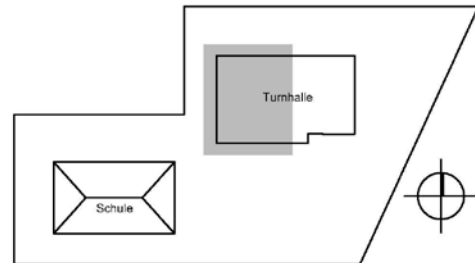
Beispiel Lageplan als Übersichtsplan
